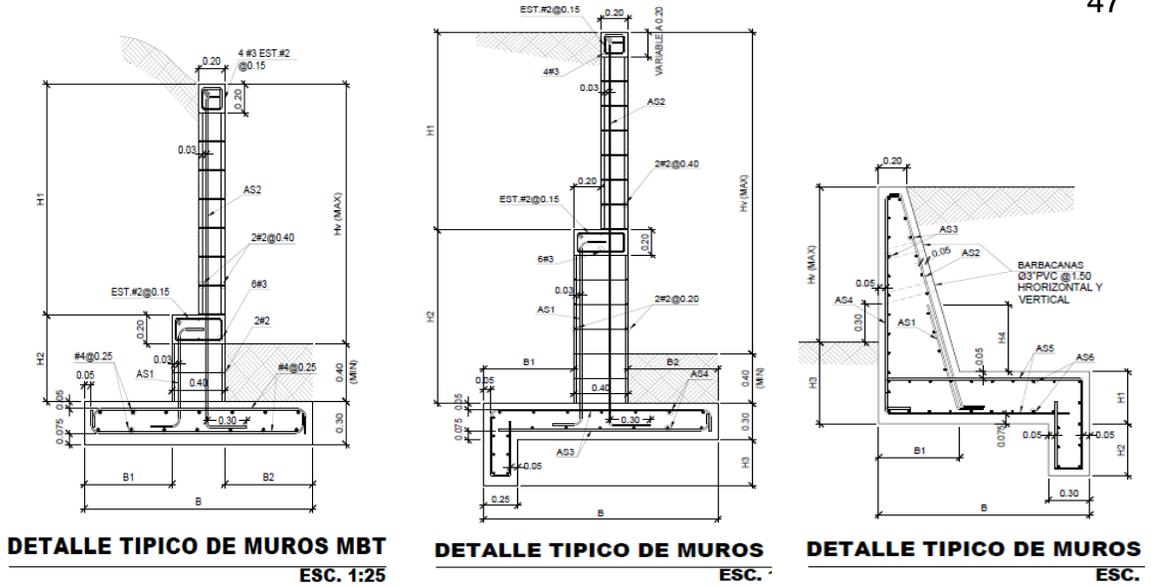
SECCIONES TÍPICAS DE MUROS DE RETENCIÓN EN VOLADIZO
